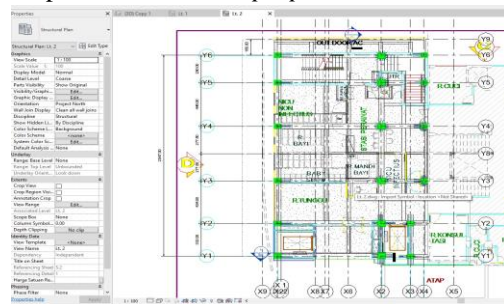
8 *Tools Wall Structure* pada *structure panel
